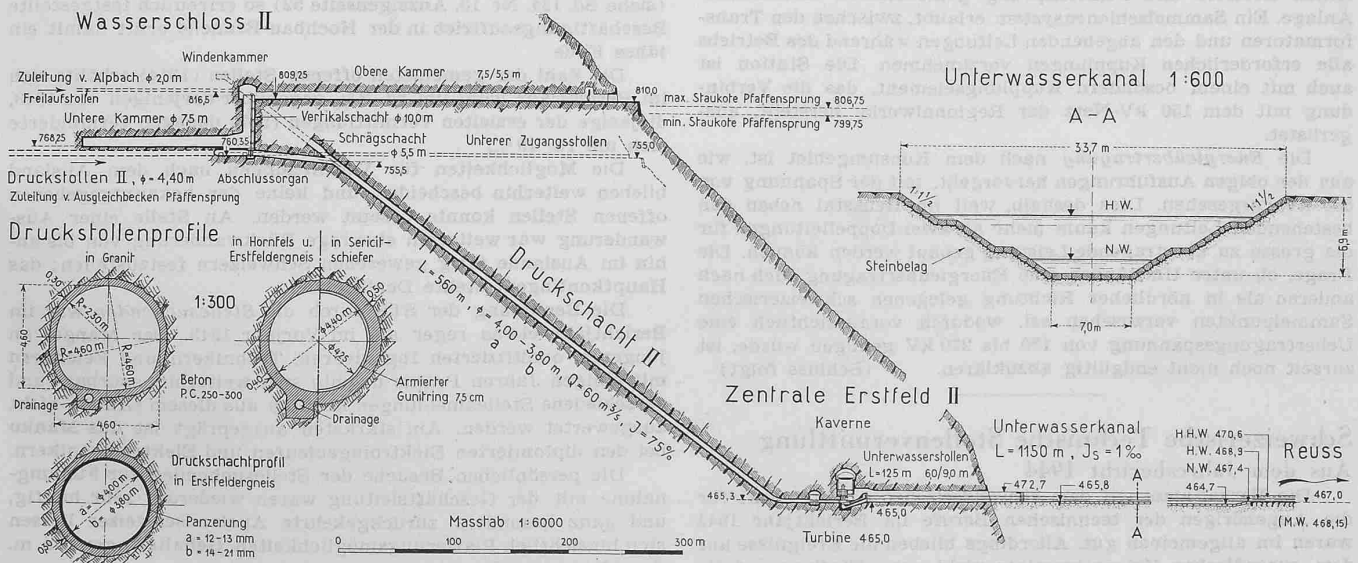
Hauptkraftwerk Erstfeld, Längenprofil Werk II, Masstab 1:6000, Stollenprofile 1:300 und Unterwasserkanal 1:600
